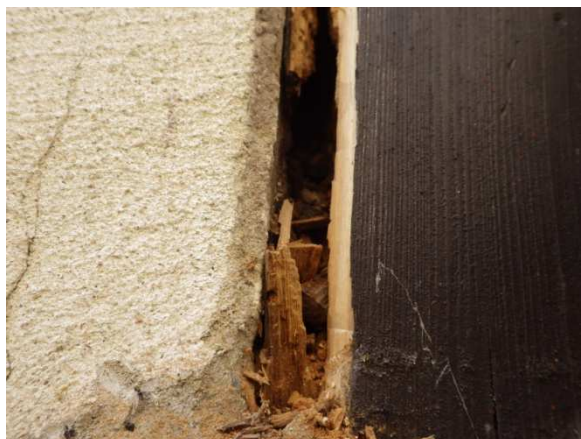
venkovní dřevěné hrázdění – detaily napadení prvků
